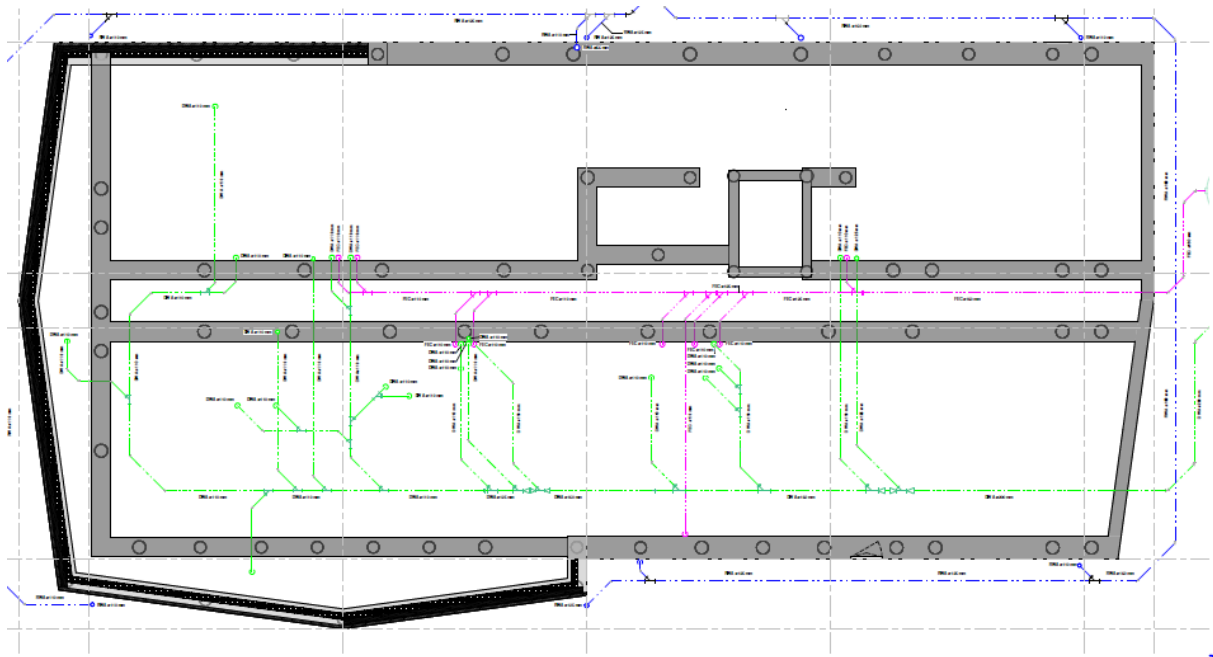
Uitsnede uit snede gebouw A. (Plan aangeleverd door architect B2A1).
